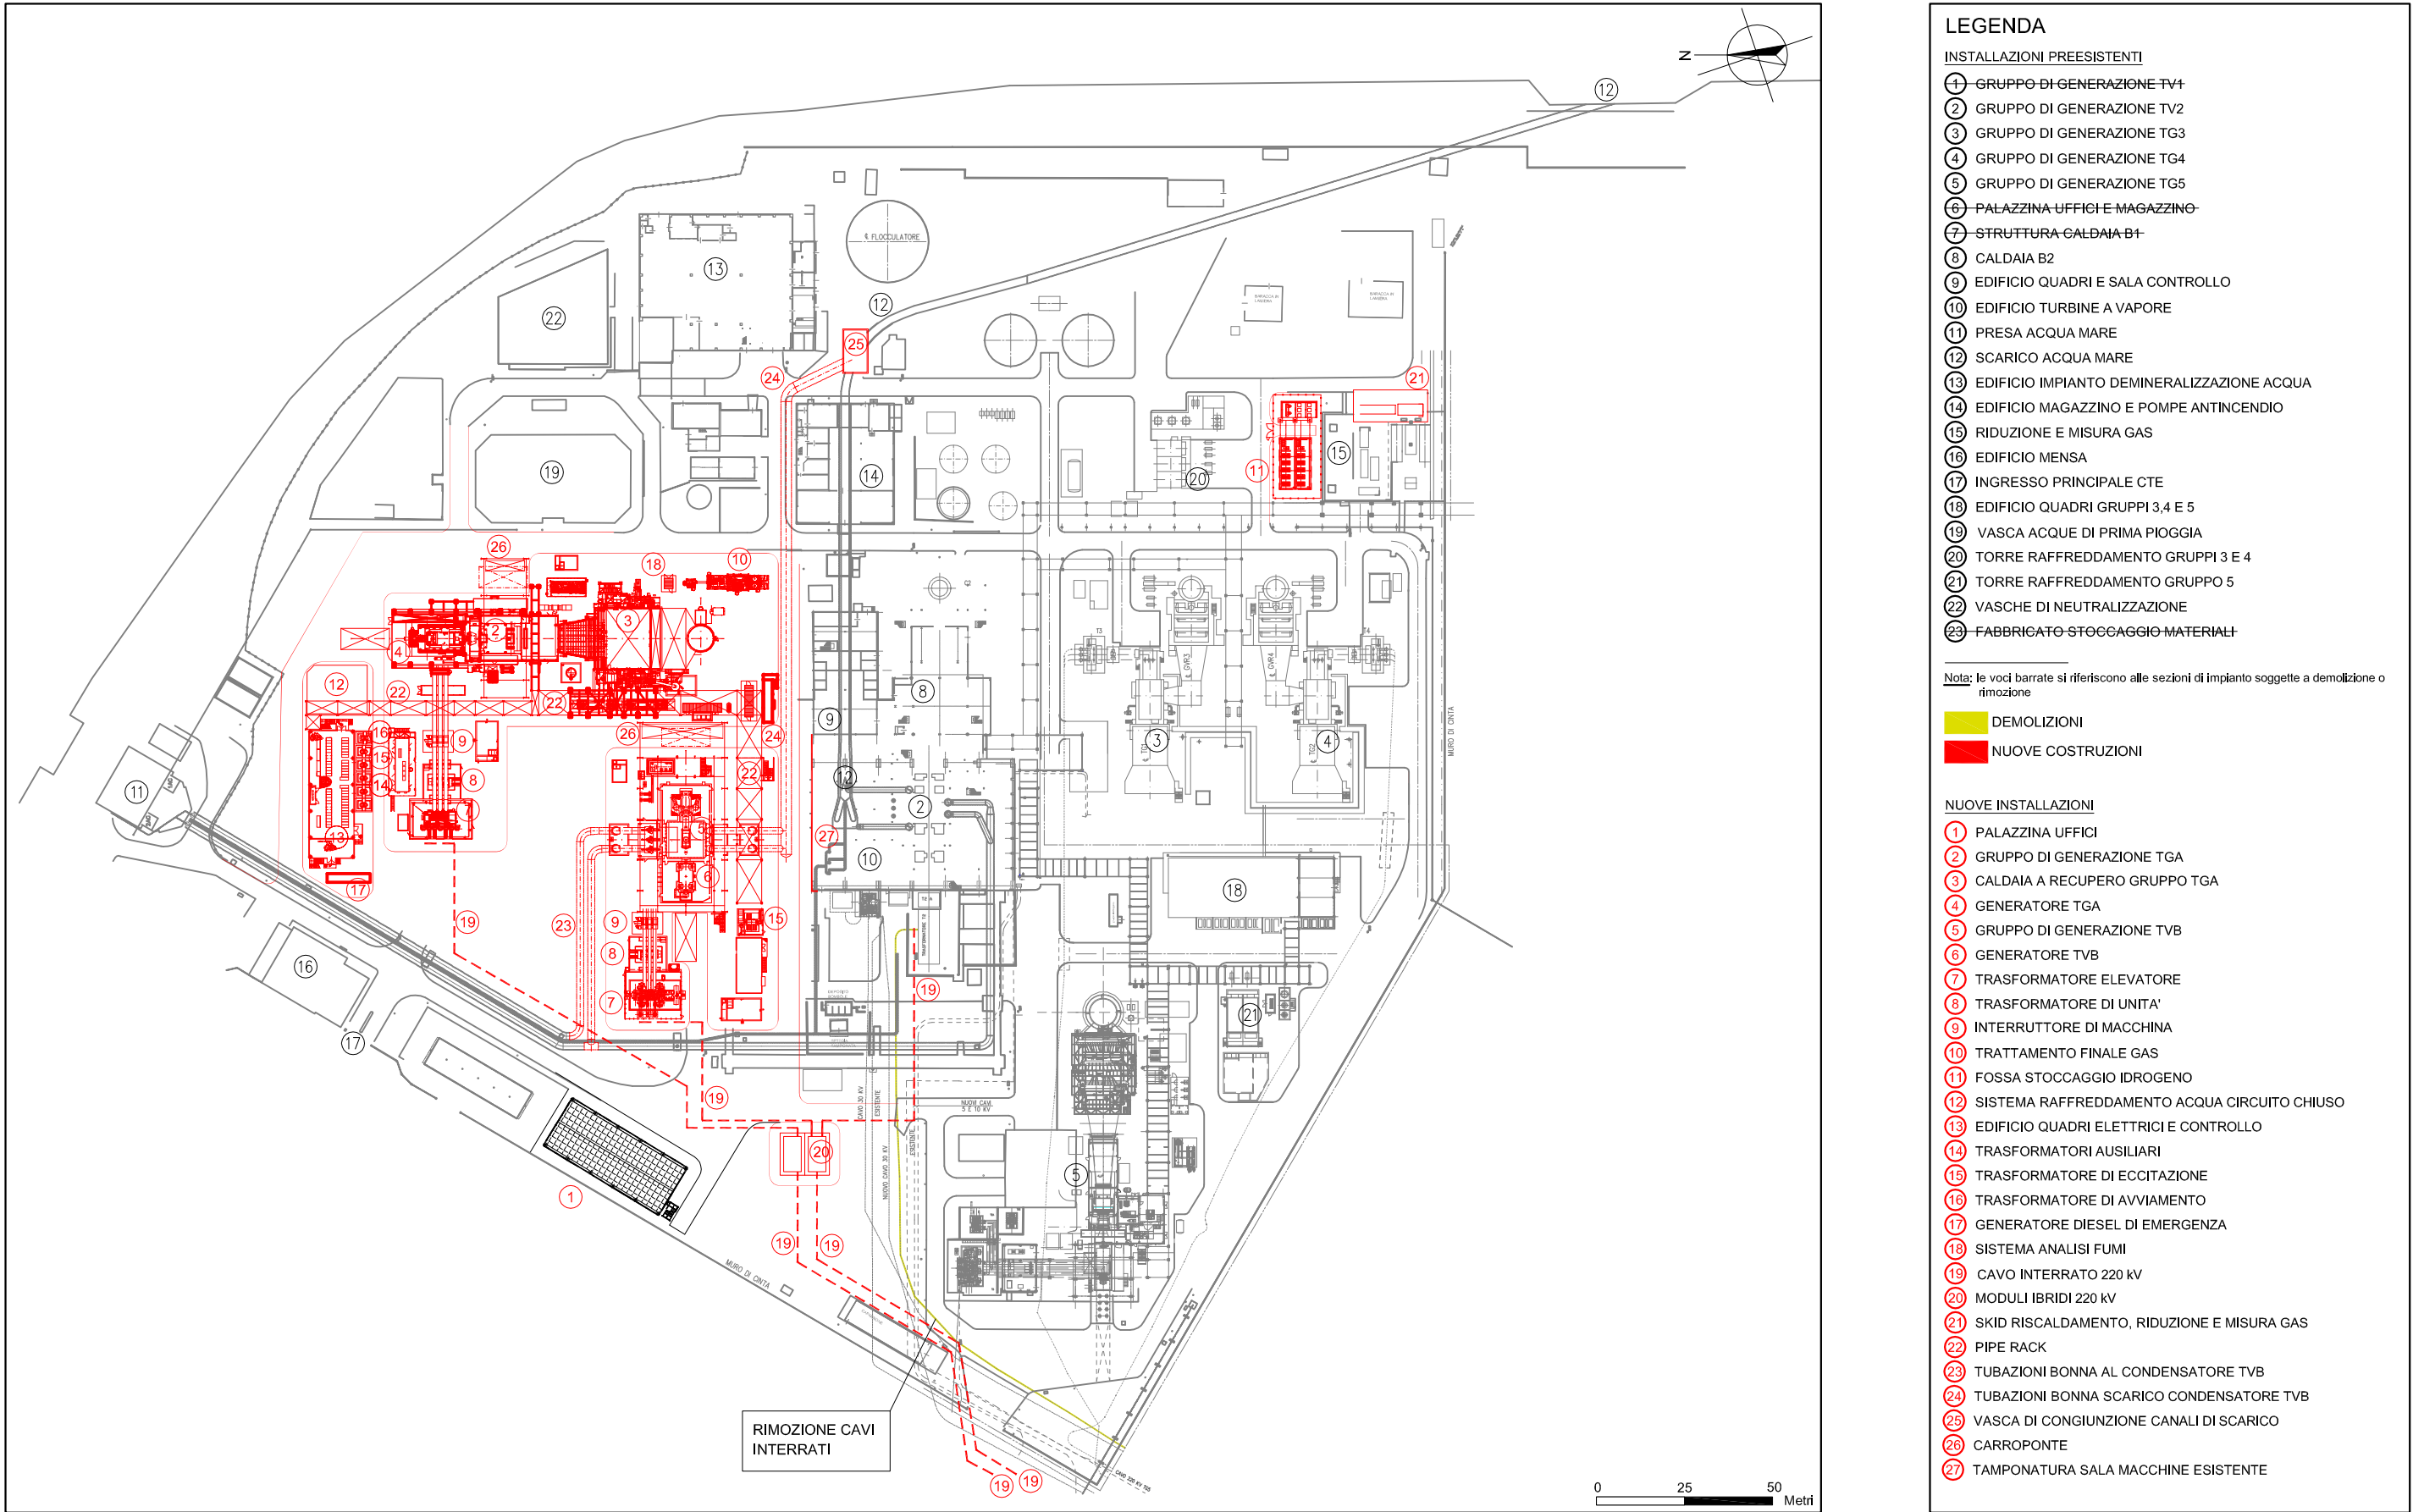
Fase 5 - Demolizione apparecchiature obsolete e dismesse
